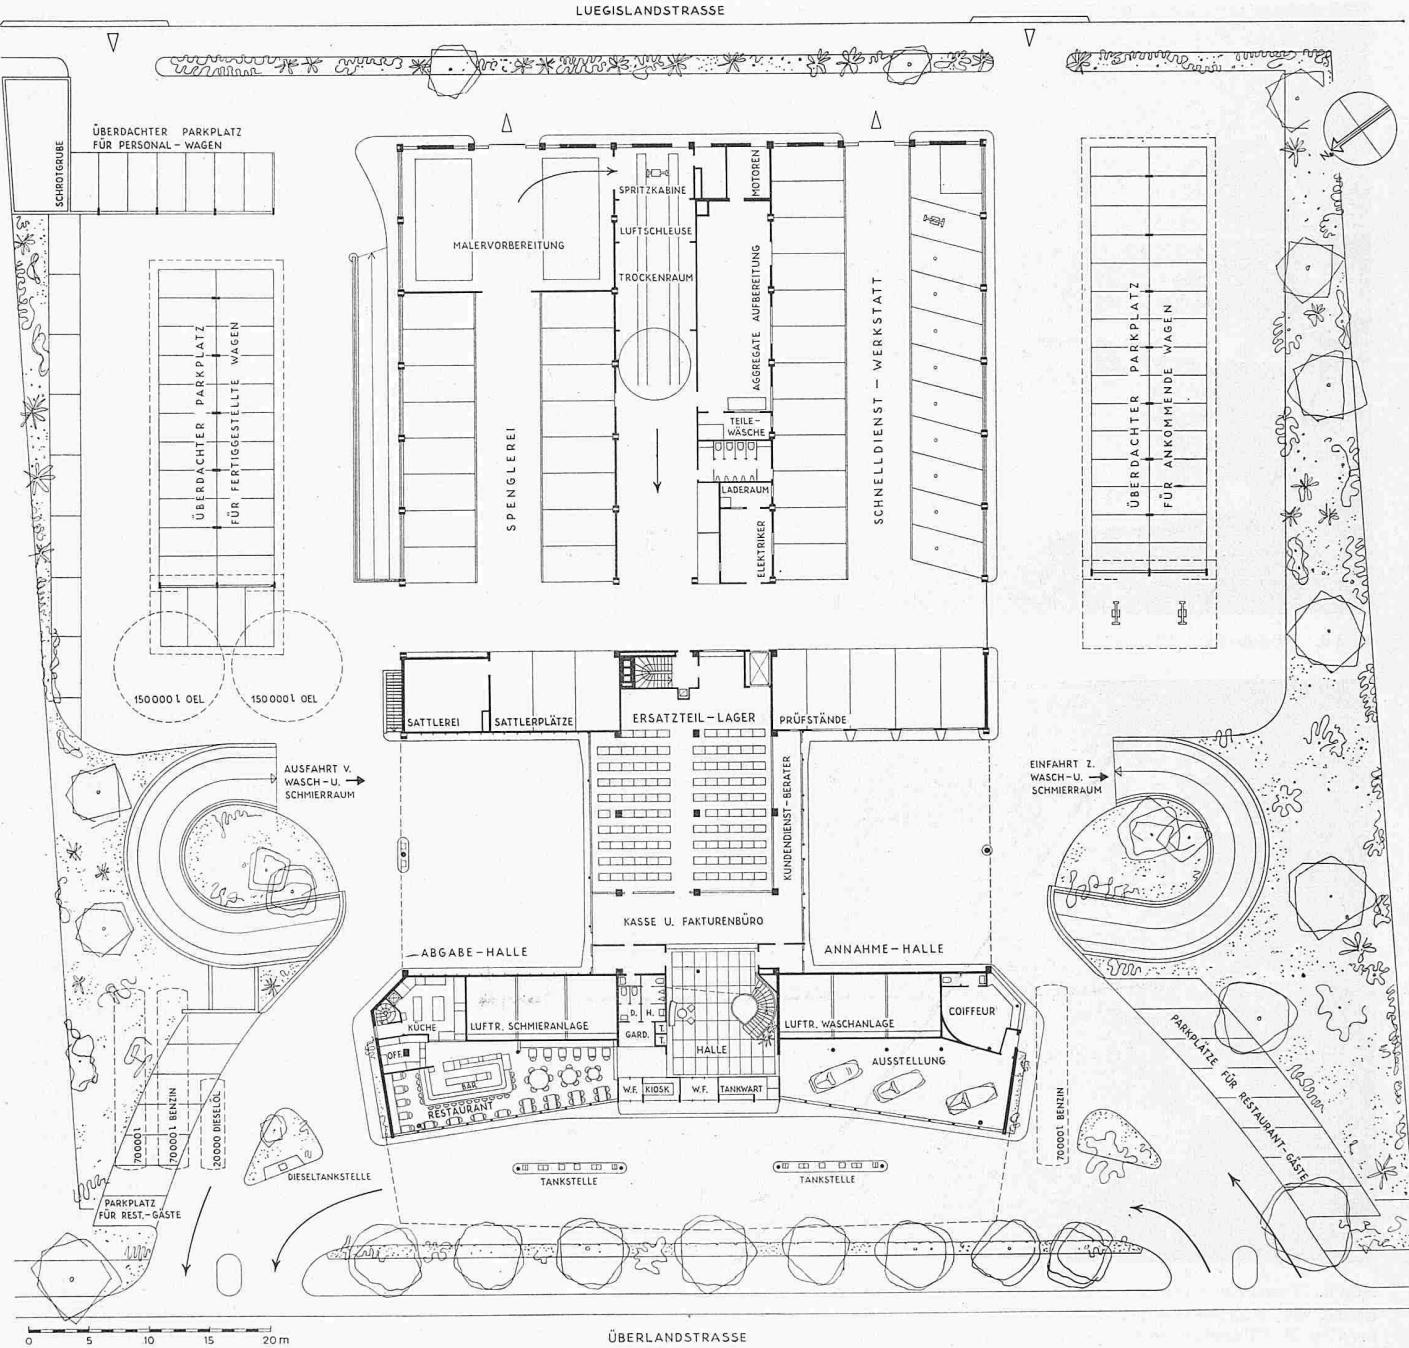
(oben). Grundriss des Erdgeschosses 1:600
